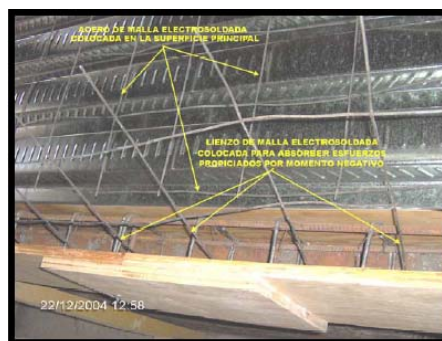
Colocación de la malla electro soldada en losa y cadena perimetral
